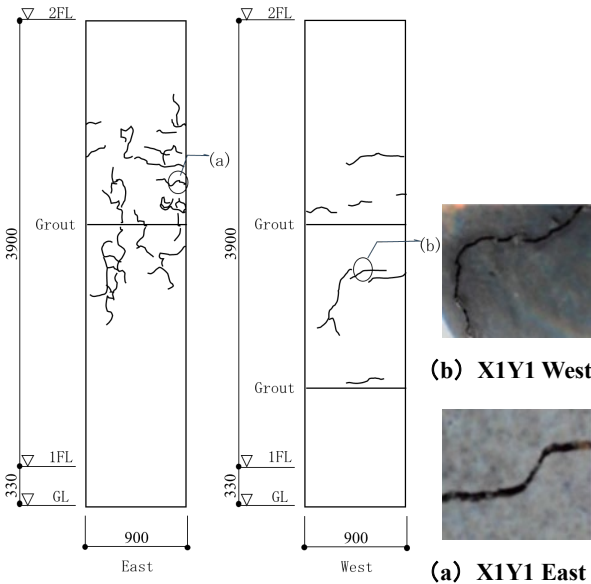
ひび割れ状況図 図-9 ひび割れ写真 (X1Y1 East-West Face)
